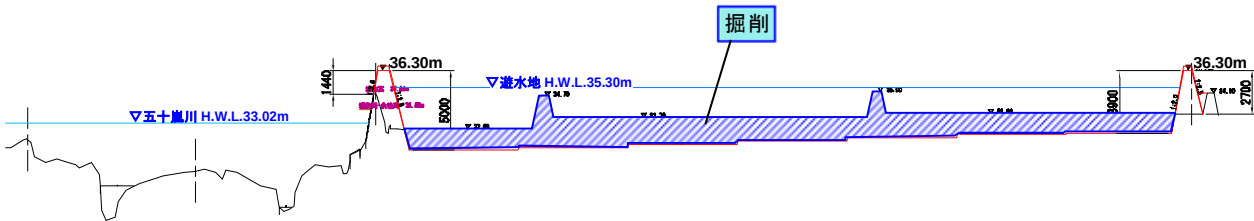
遊水地②（11.8k 右岸）横断面図
